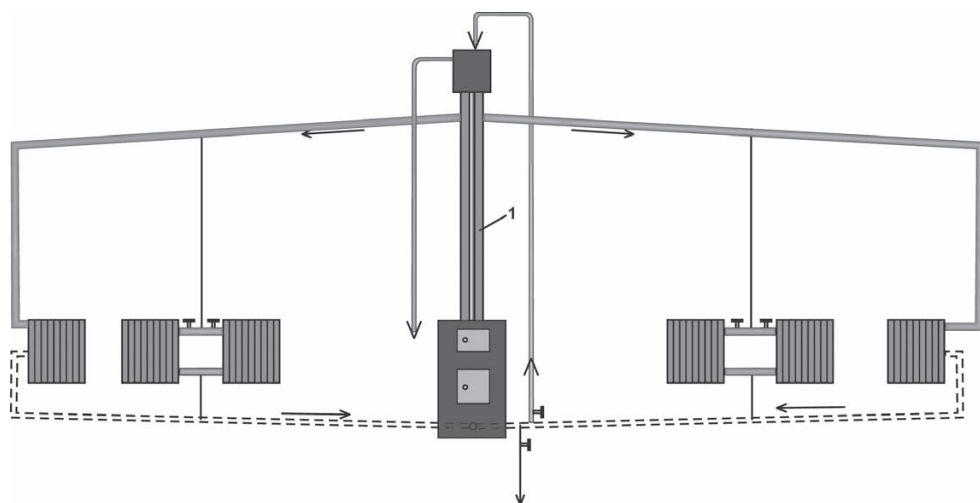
Изоляция главного стояка: 1 — теплоизоляция главного стояка
